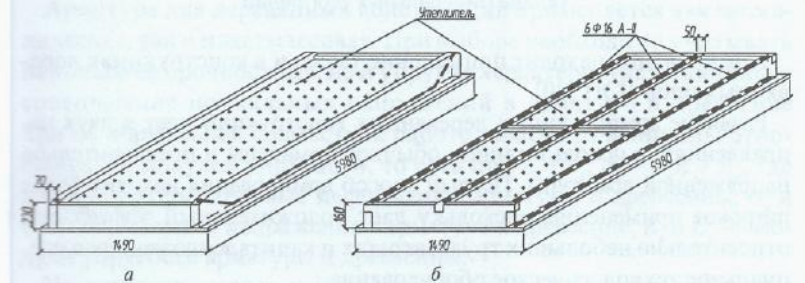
Плиты покрытия с армированным деревянным каркасом и асбестоцементной нижней обшивкой: а – арматура в ребрах плиты с предварительным напряжением; б – ребра плиты армированы без предварительного напряжения
